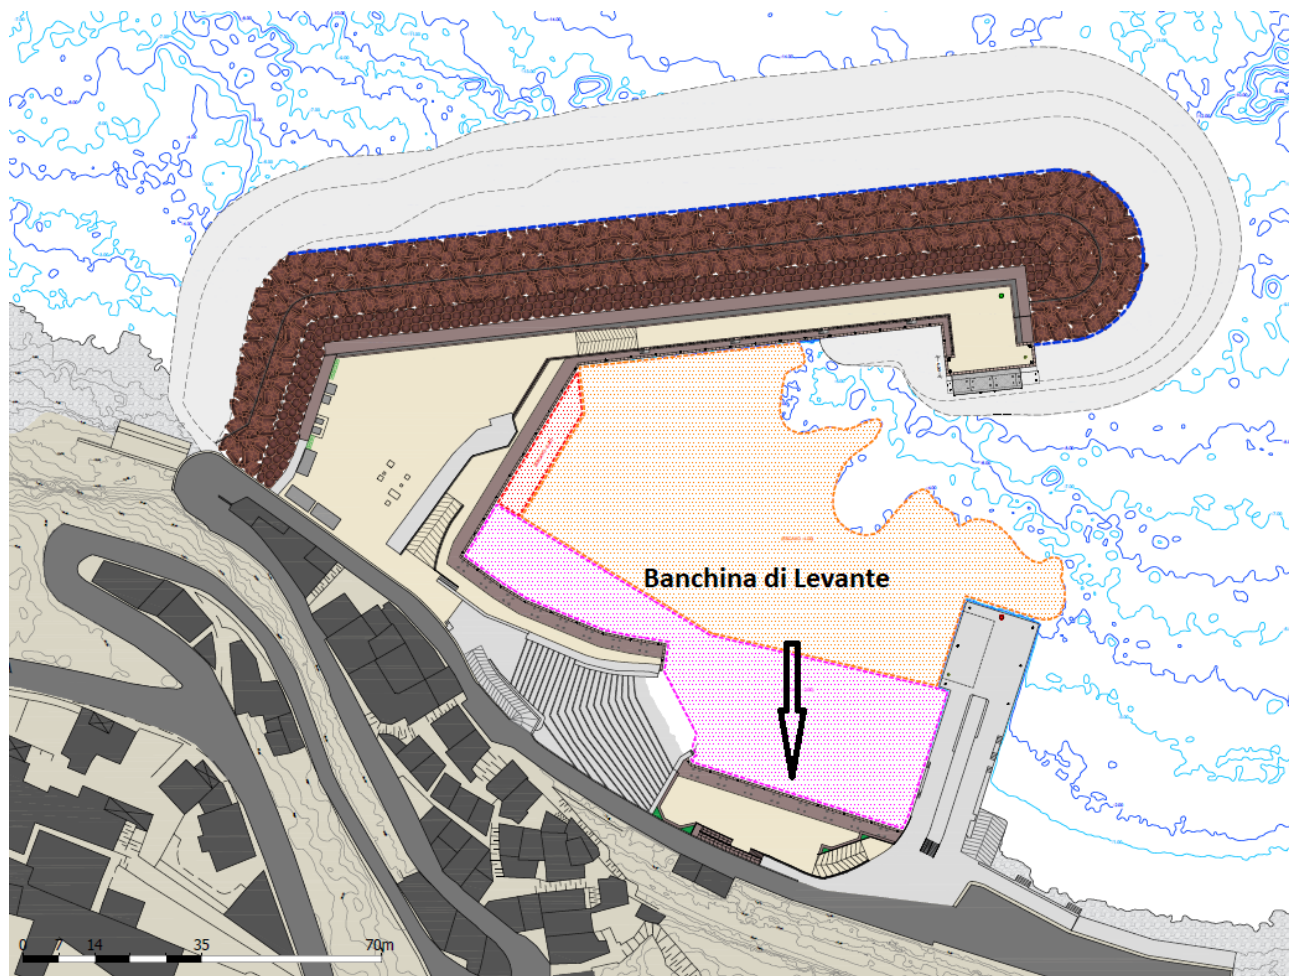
Planimetria generale delle opere in progetto con indicazione della banchina di levante avente uno sviluppo di 44,40 m
